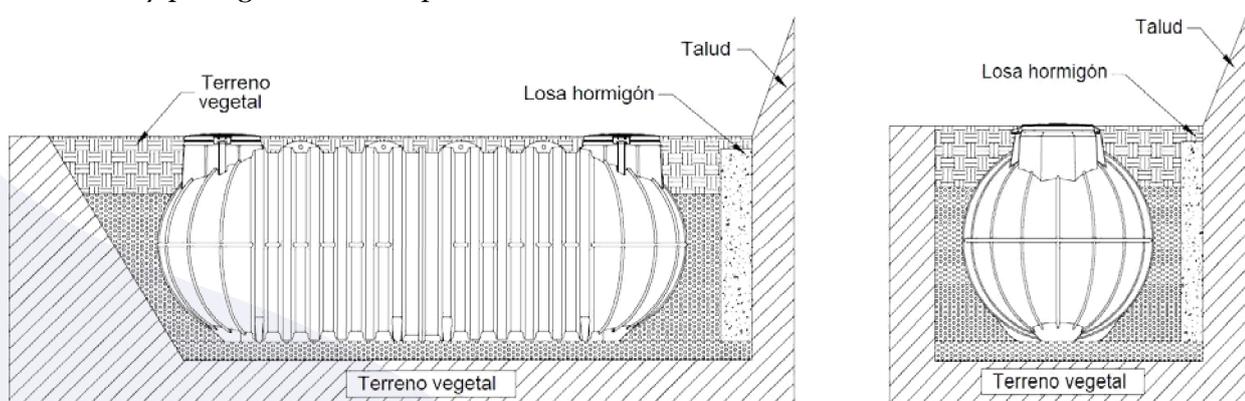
Ilustración VIII: Colocación de losa de hormigón vertical en terrenos inclinados.
